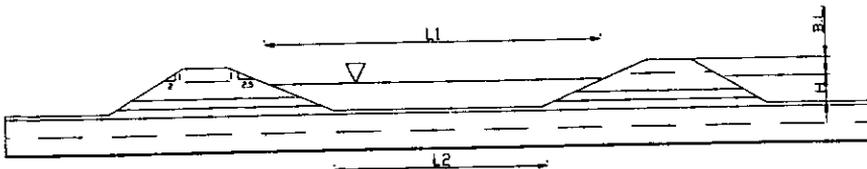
Arreglo final de las lagunas de estabilización
